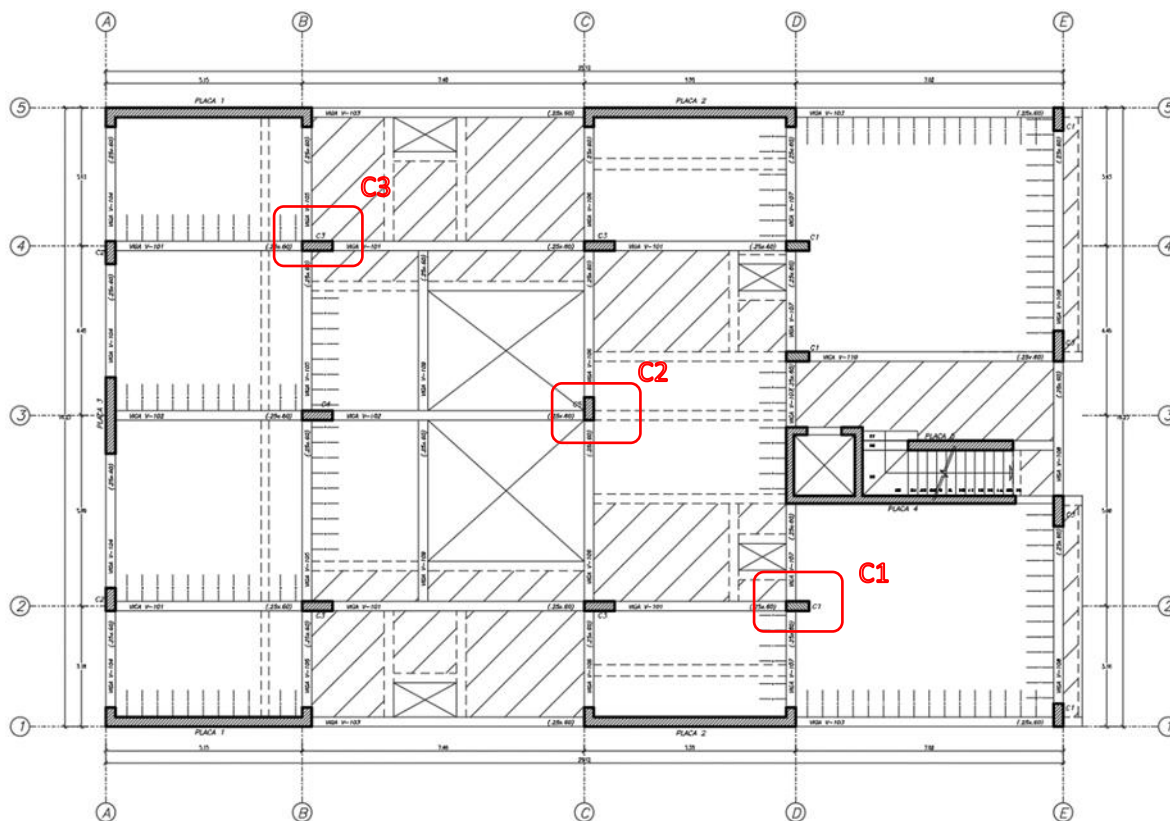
Ubicación de las columnas elegidas para diseñar.
